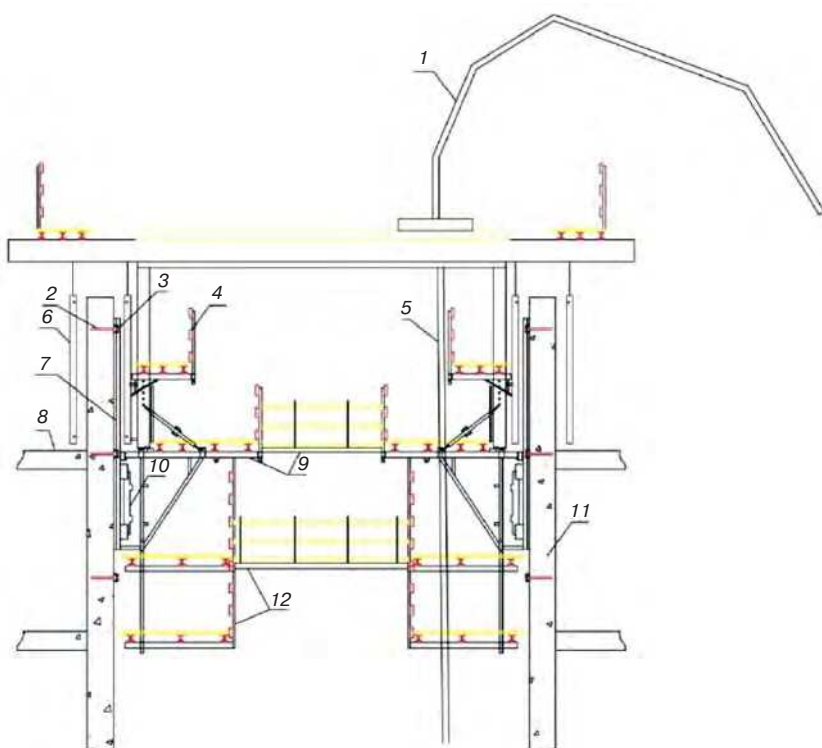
Система самоподъемной опалубки с распределительной стрелой при возведении монолитного здания: 1 – распределительная стрела; 2 – крепежный анкер; 3 – навесной башмак с гравитационным механизмом; 4 – подмости для выполнения бетонных работ и вибрирования; 5 – бетоновод; 6 – щит опалубки; 7 – направляющая балка; 8 – железобетонное монолитное перекрытие; 9 – подмости рабочие; 10 – гидравлический домкрат; 11 – железобетонная монолитная стена; 12 – подмости нижние
